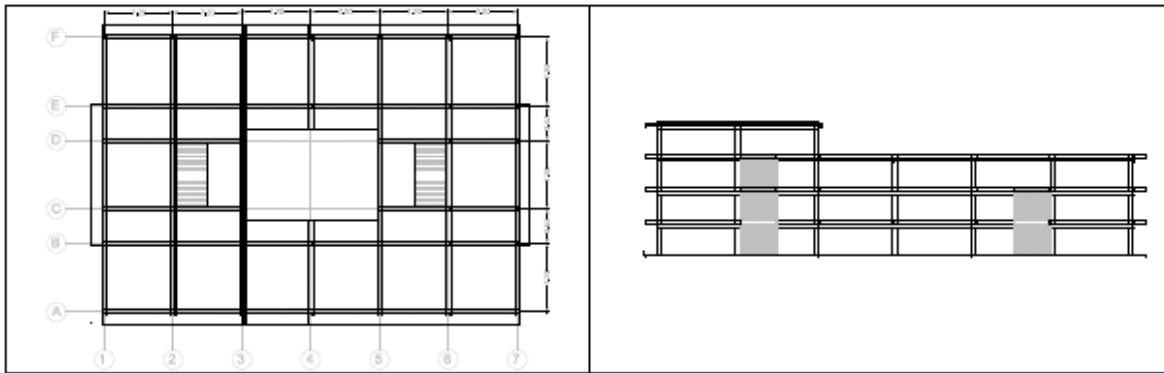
Plano de planta (izquierda) y pórtico en dirección longitudinal (derecha)
